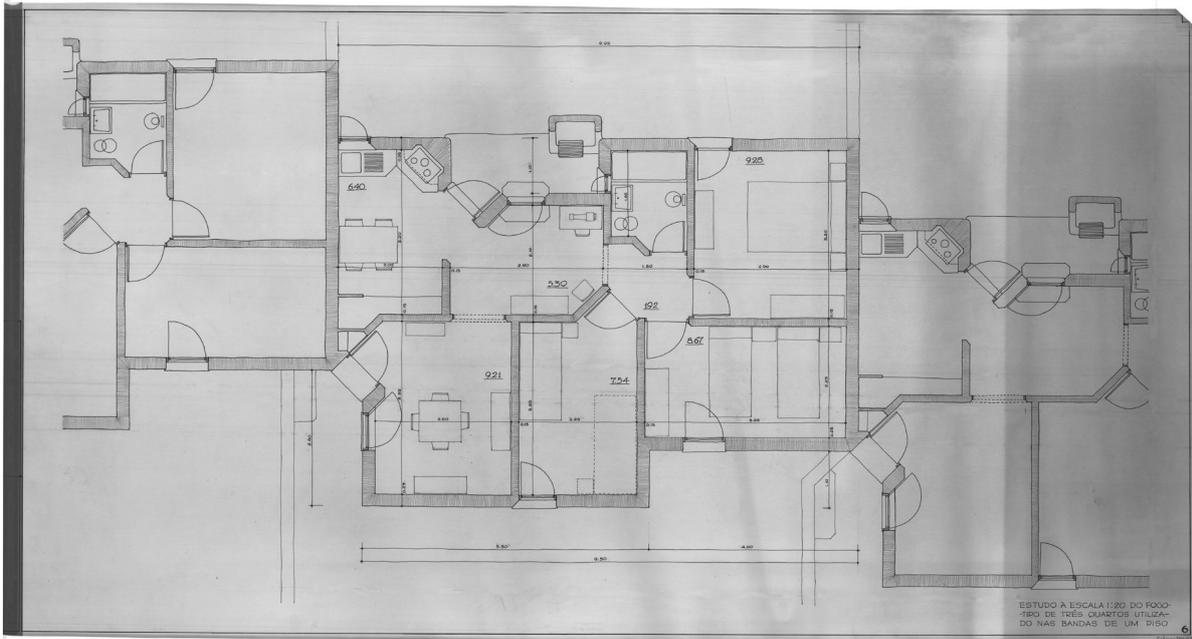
Anteprojeto: banda de 1 piso - planta do T3
